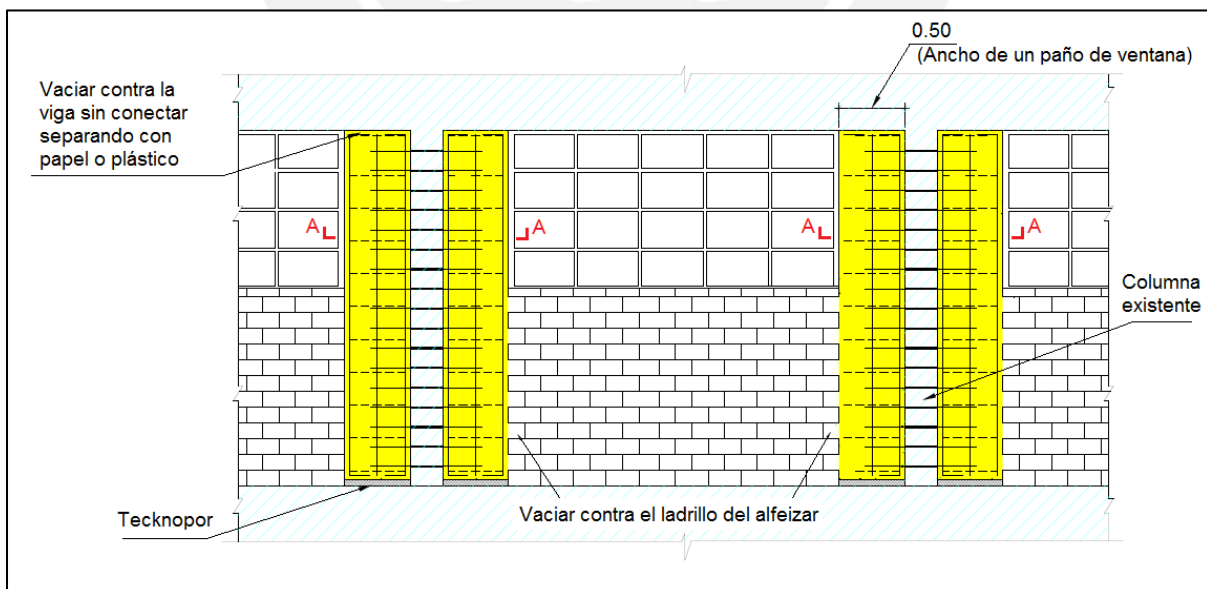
Elevación del pórtico reforzado con "aletas" de concreto
